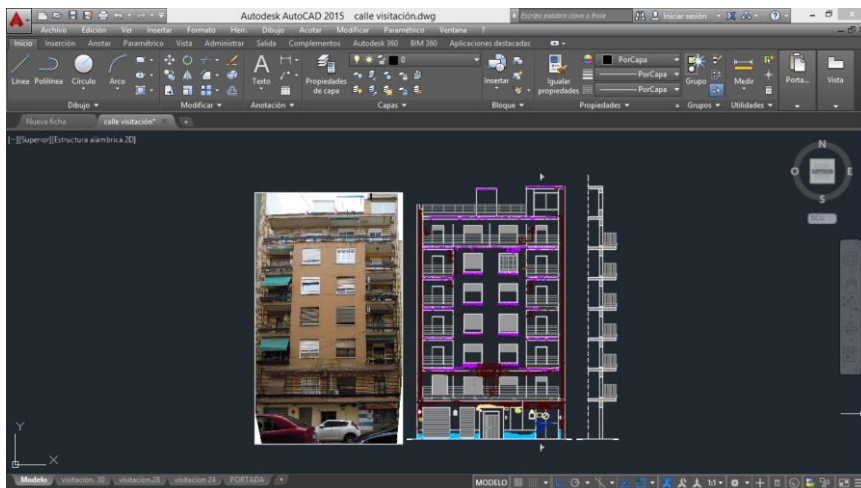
Levantamiento realizado con AutoCAD. Marzo 2015.
